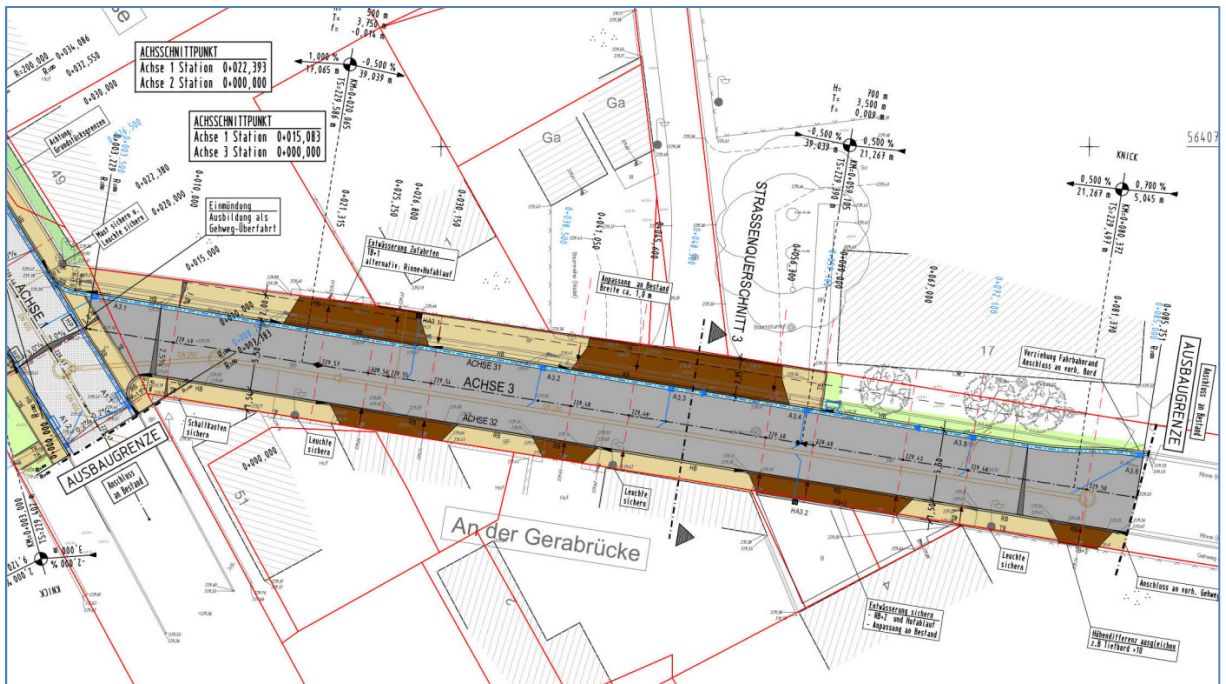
Auszug aus Lageplan An der Gerabrücke (Achse 3)
